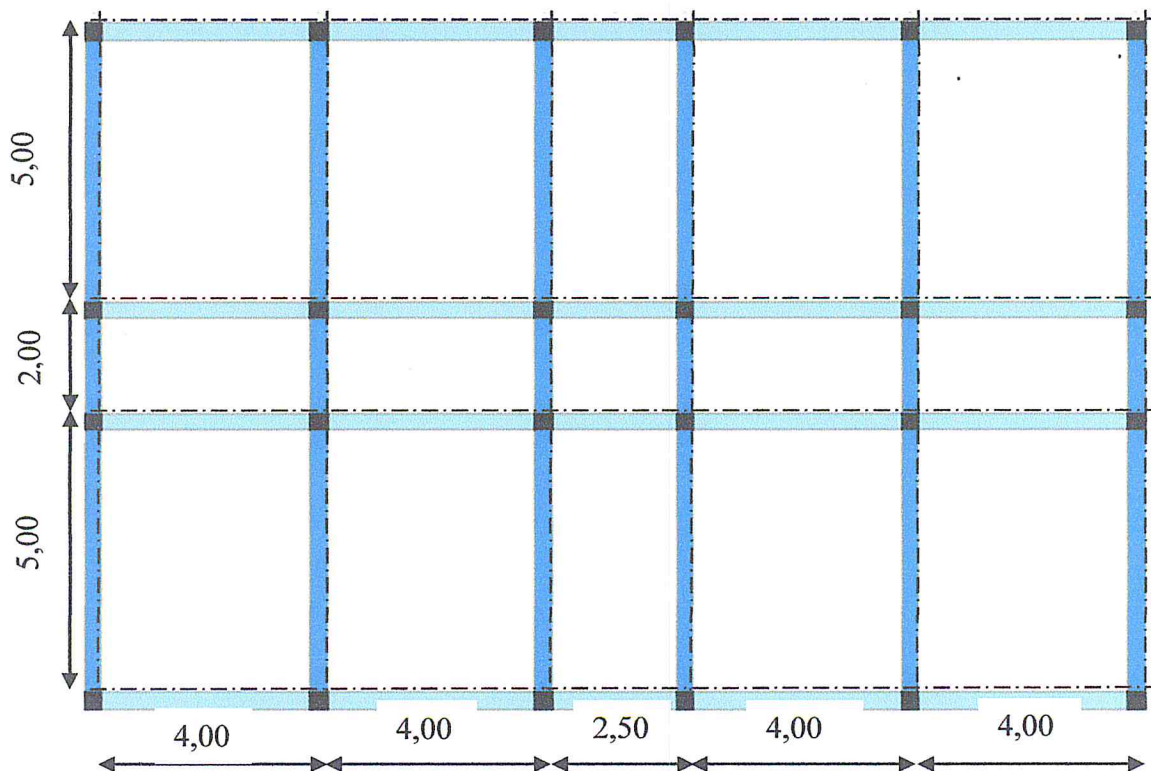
Vue en plan du bâtiment en béton armé à 5 étages
